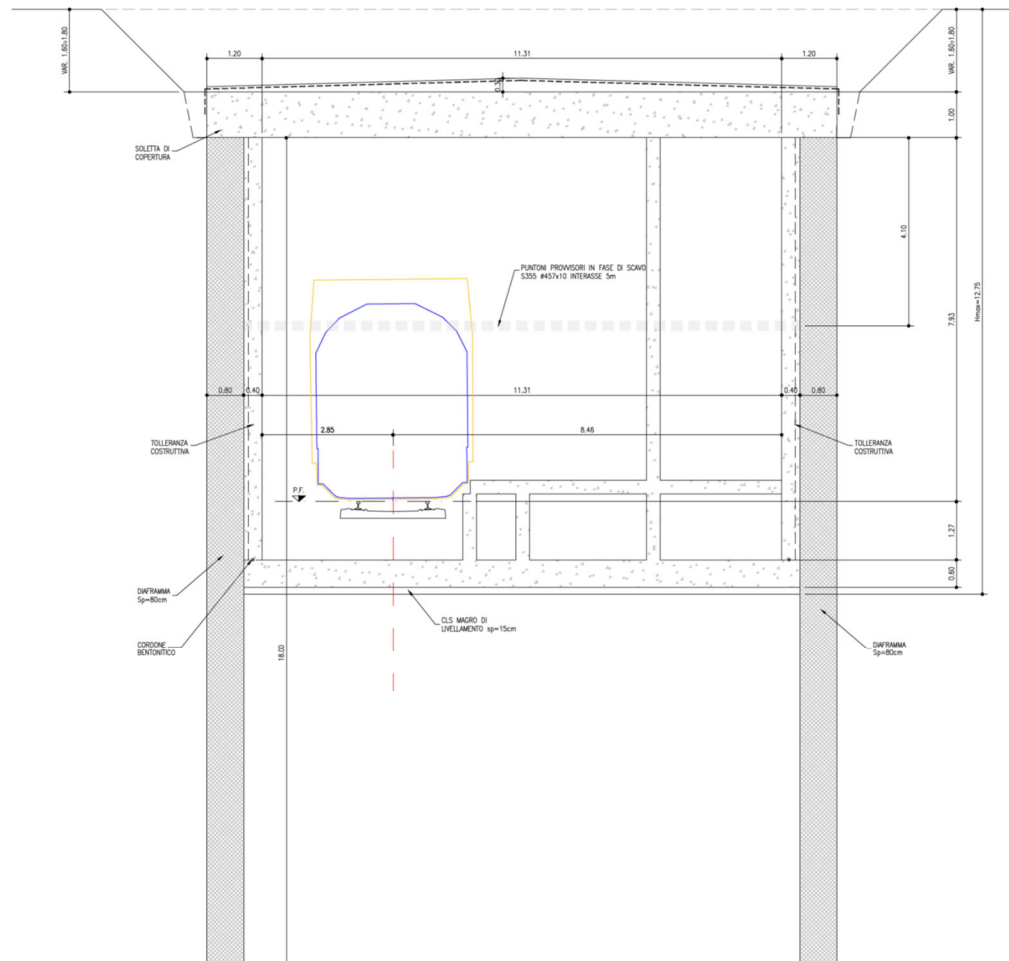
Scavo con diaframmi – sezione TIPO Lb3
